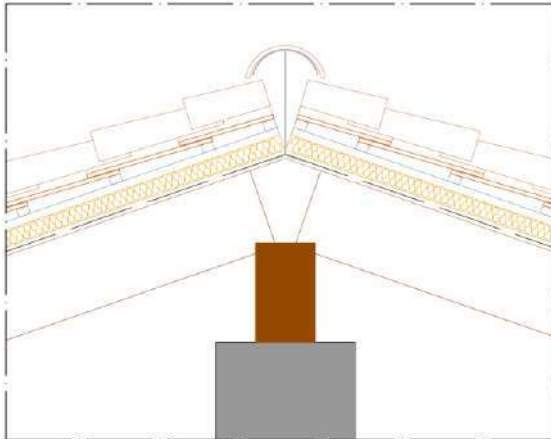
Detalle de propuesta de cumbrera, apoyo en muro central. 2016. Fuente Propia
